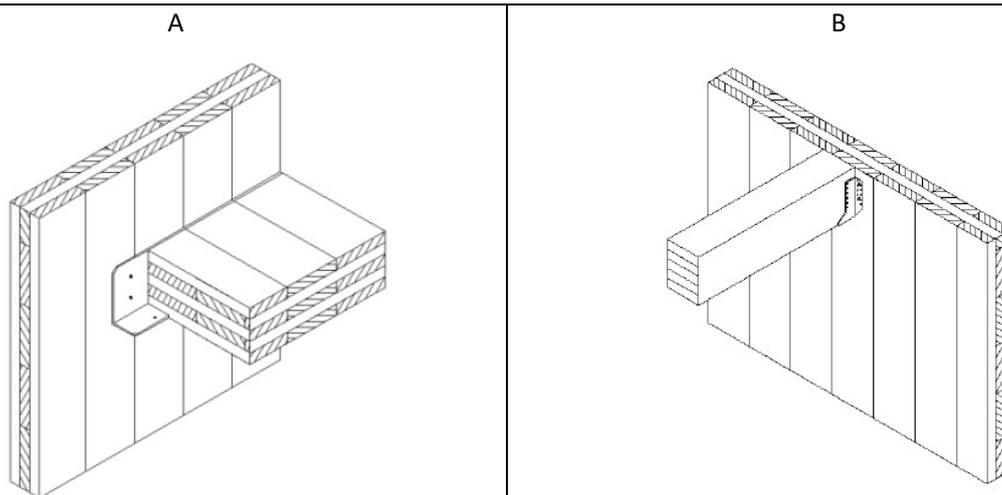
Soluzioni per il collegamento di interpiano con parete continua. A Appoggio del solaio di interpiano su parete continua: collegamento mediante angolare metallico avvitato alla parete. B Collegamento di una trave alla parete mediante scarpie metalliche
